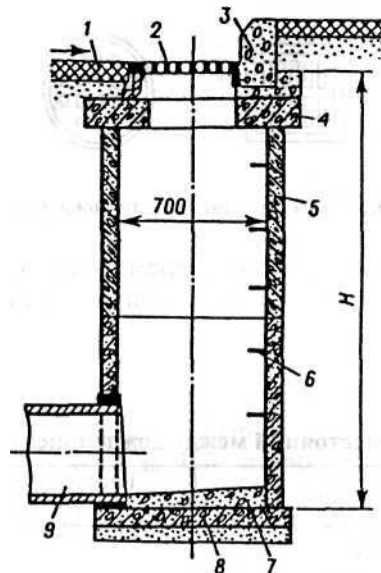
Дощоприймач із збірних залізобетонних елементів:
